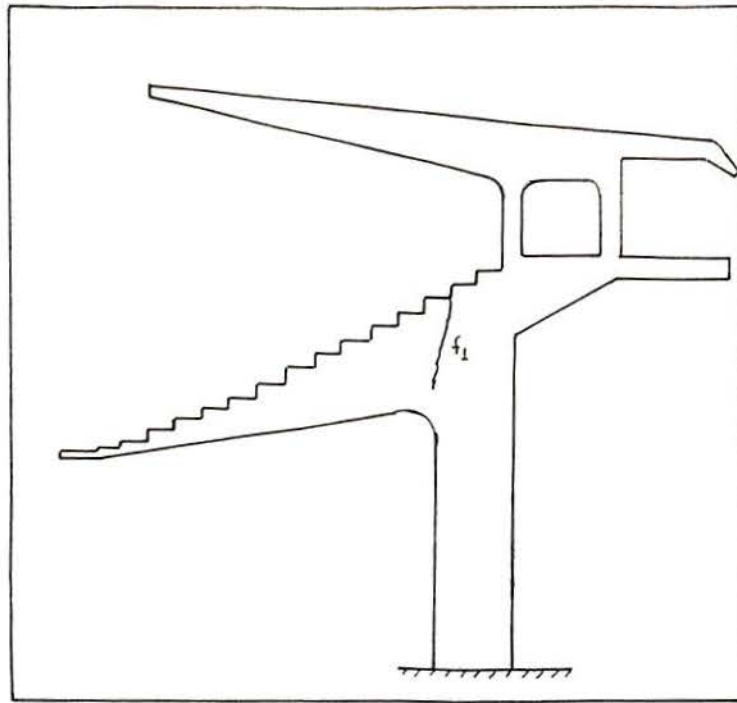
Esquema de fissuras no pórtico 2 para 12 KN.
